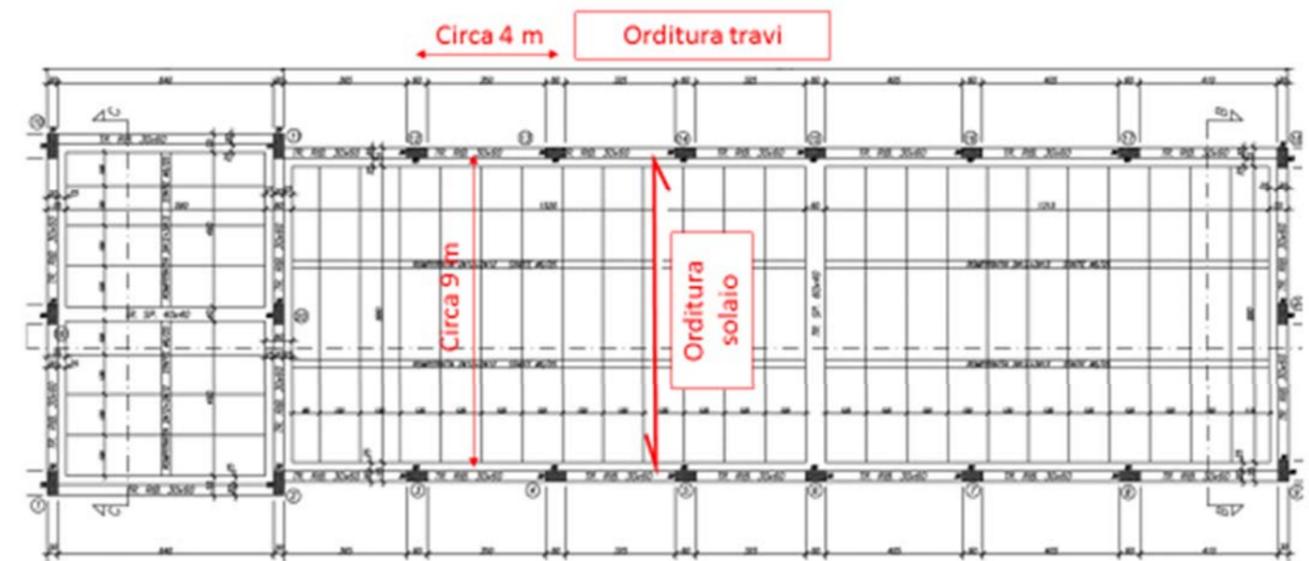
Vista in pianta dell'orditura tipo per le cabine
